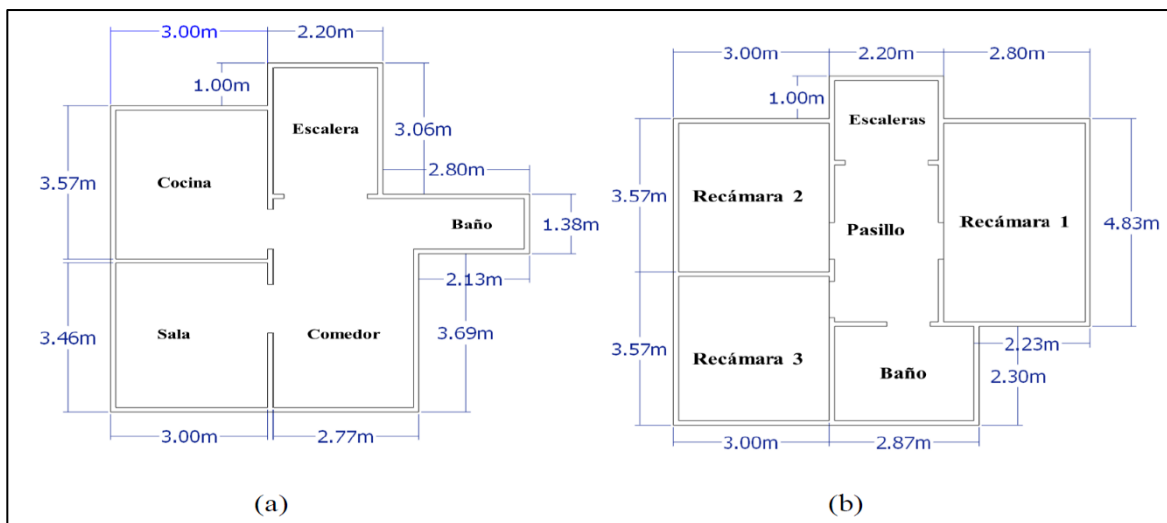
14. Vivienda de referencia a) Plano planta baja b) Plano planta alta
